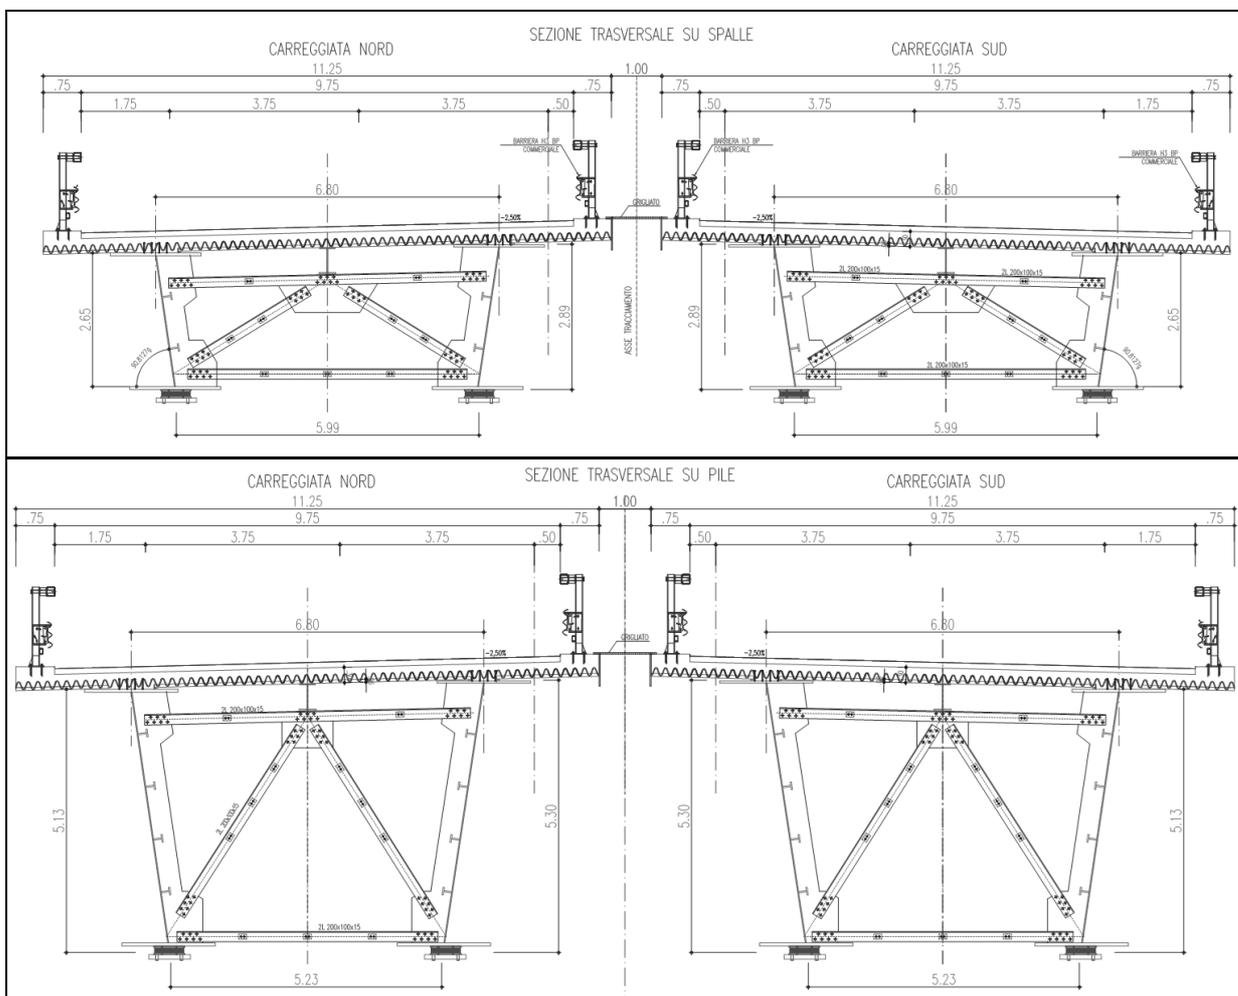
Sezione trasversale in asse spalle (sopra) e pile (sotto)
